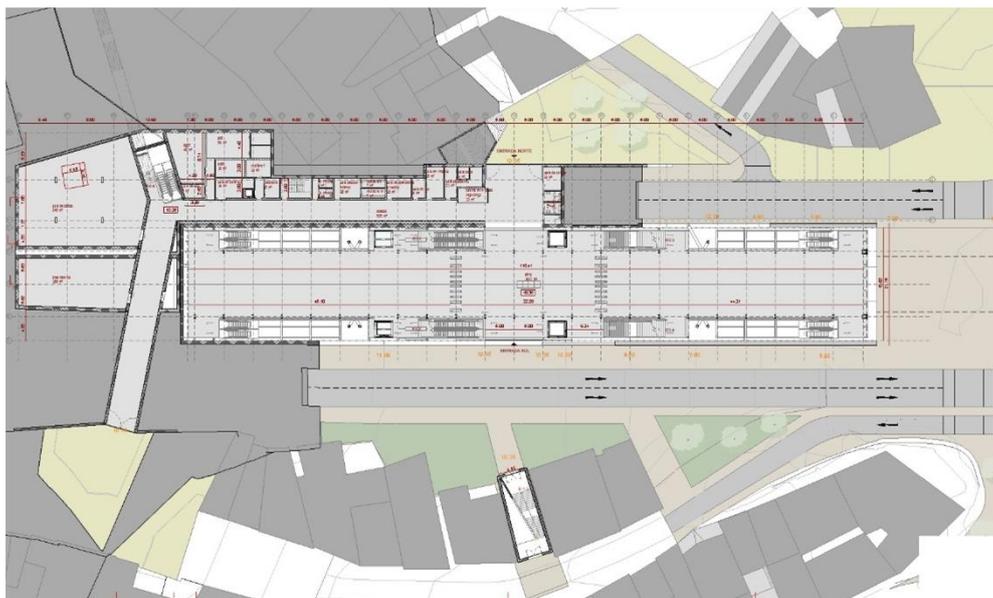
Planta Piso 0 - Átrio (ML 134352).
